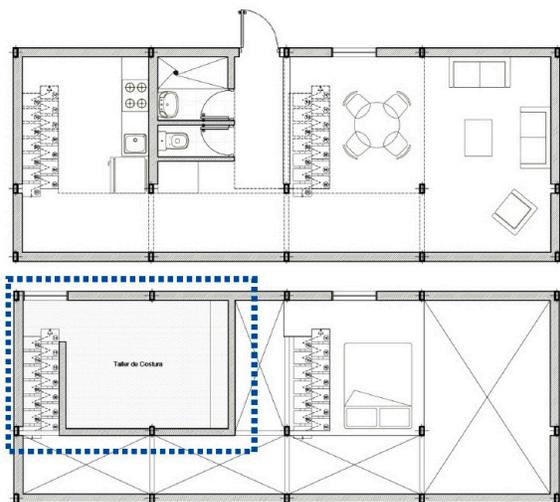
Planta baja y planta alta de la vivienda actual con espacios para la productividad anulados e incorporados a las rutinas del hogar
